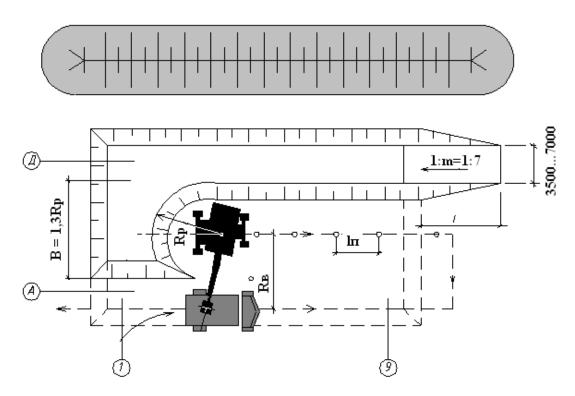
Схемы боковых проходок при устройстве котлована с погрузкой грунта в транспортные средства
